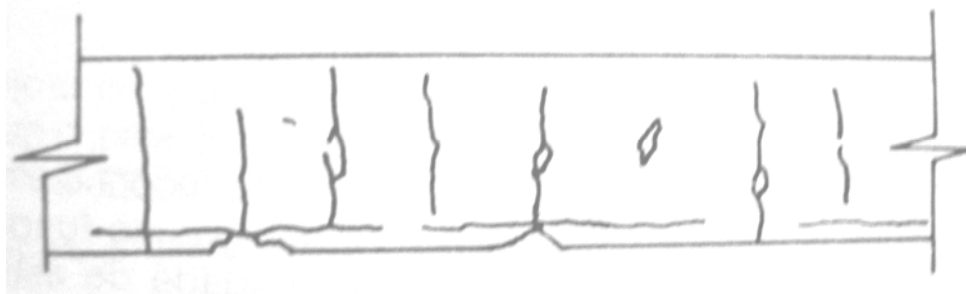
Fissuras e lascamentos em viga de concreto armado
